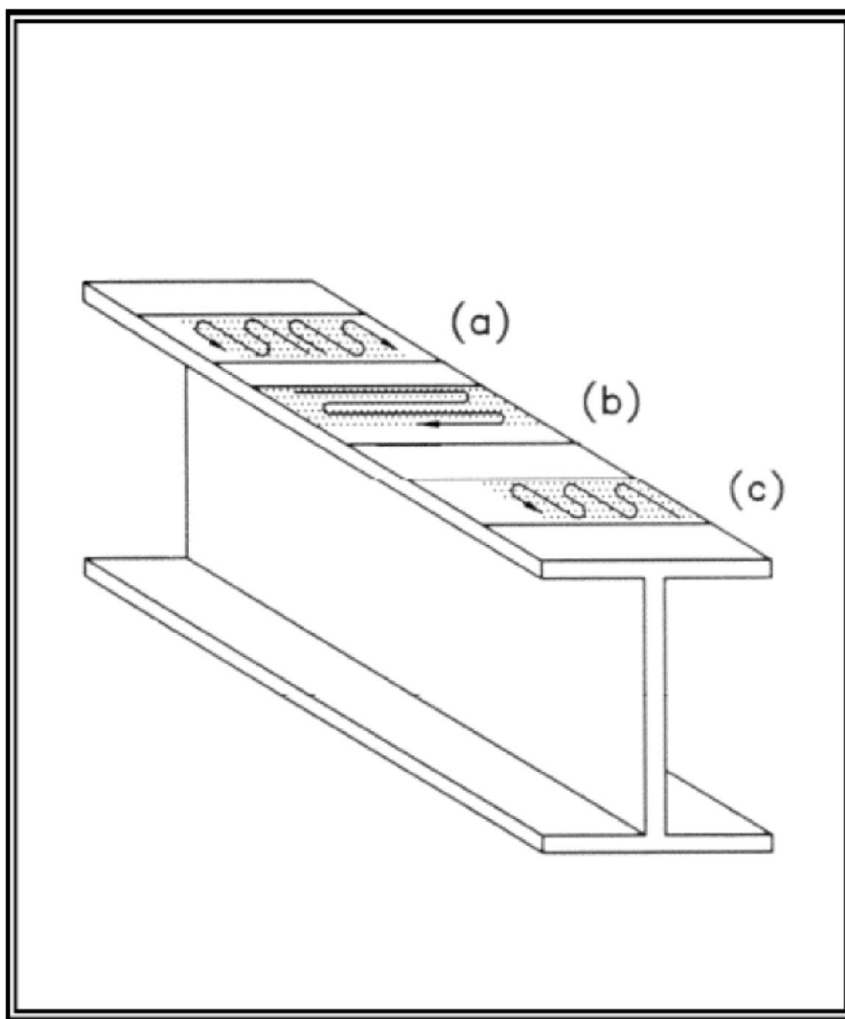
Esquema de aquecimento em tira na flange (aba) de um perfil laminado.
